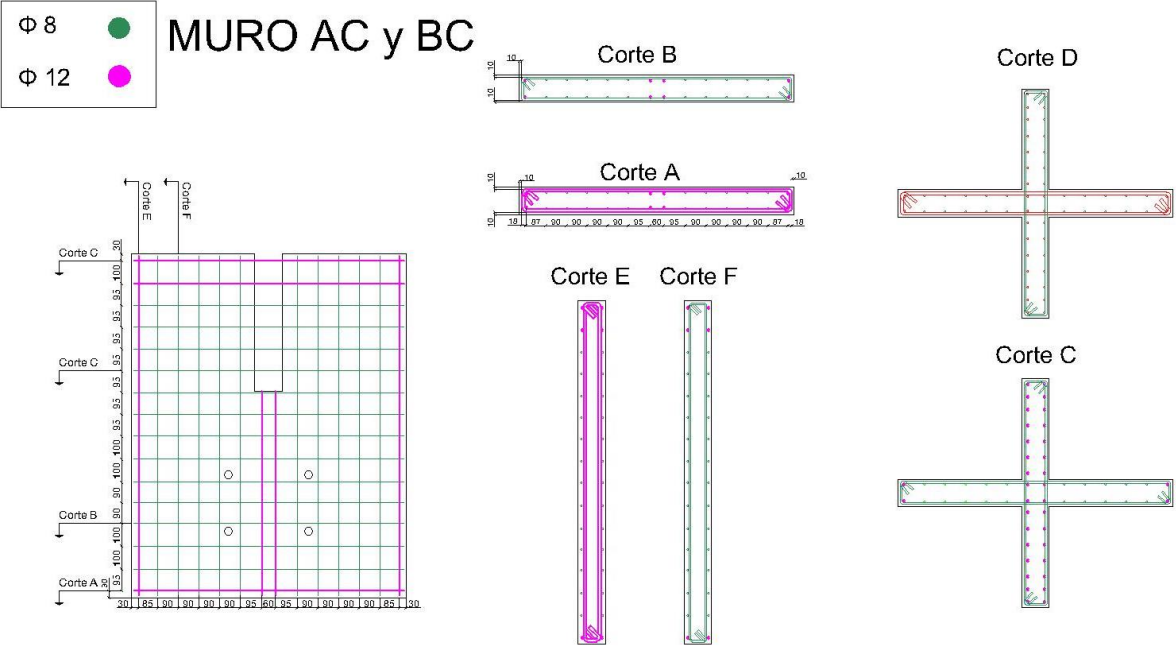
Plano de Muro AC y BC (adaptado de Sarmiento, 2024).
